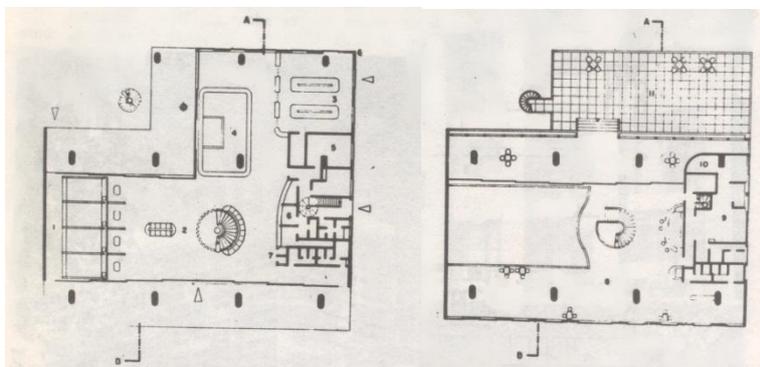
Primeiro e segundo pavimento da estação de passageiros de hidroaviões do aeroporto Santos Dumont (1938)
